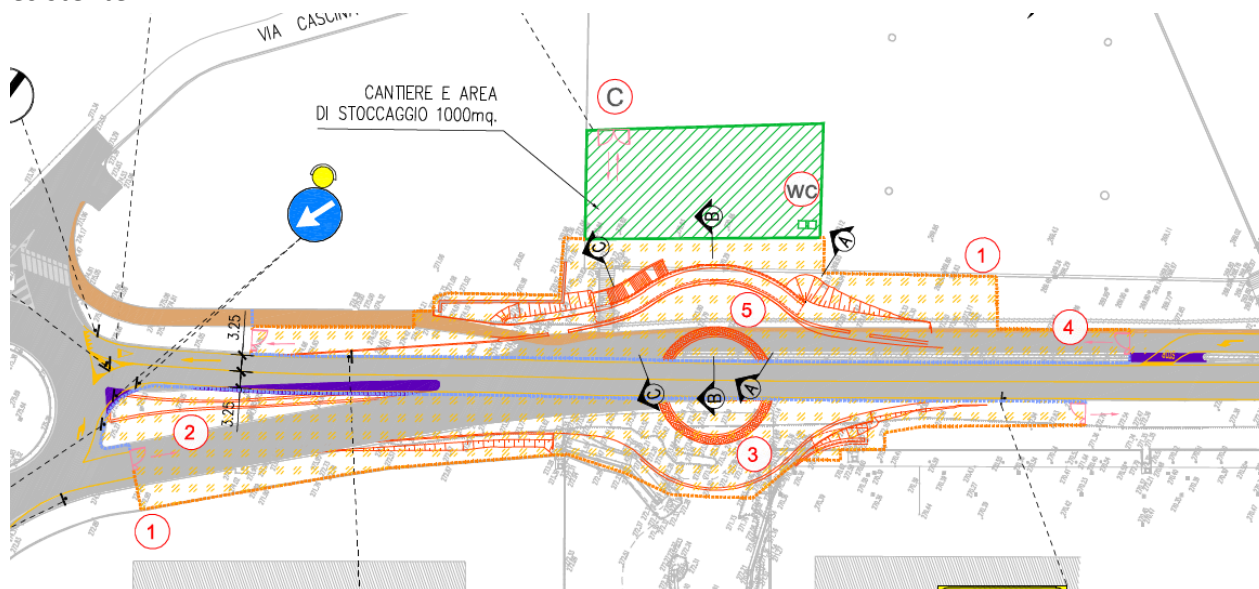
Stralcio planimetria fasi realizzative – opere esterne alla viabilità esistente
